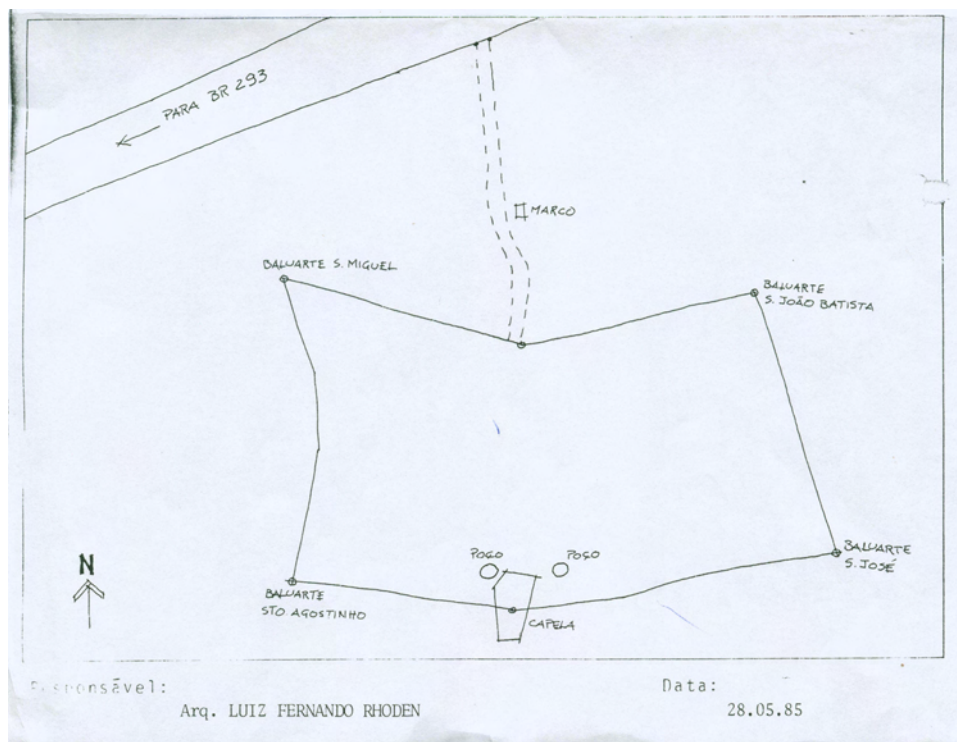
Planta 6 - Croqui da fortaleza Santa Tecla (1985)
